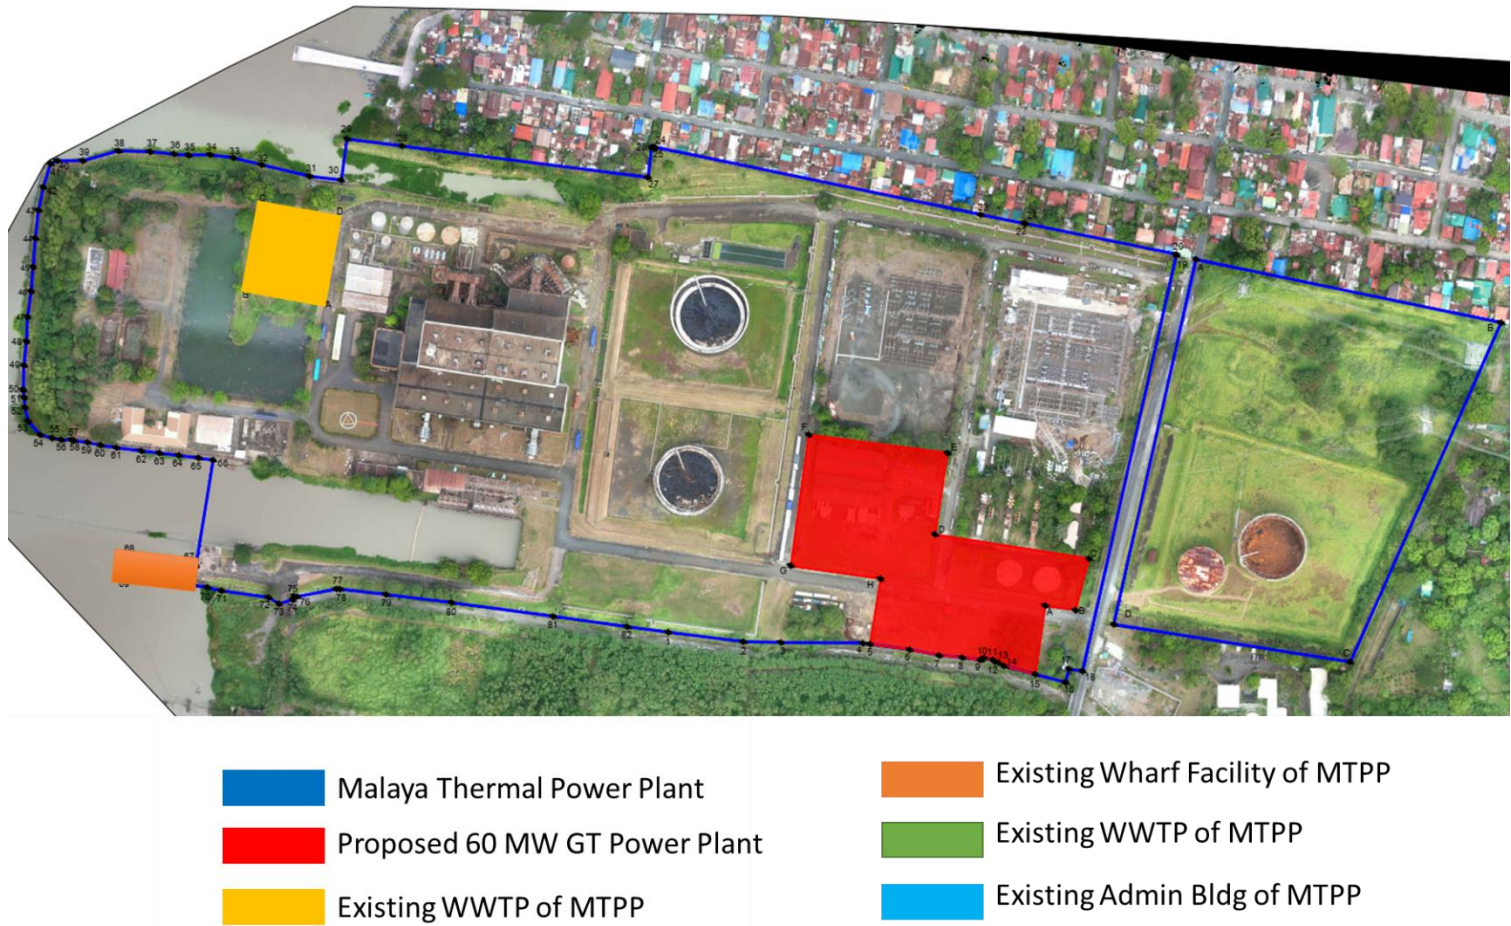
Iminungkahing Site Development Plan ng Proyekto
